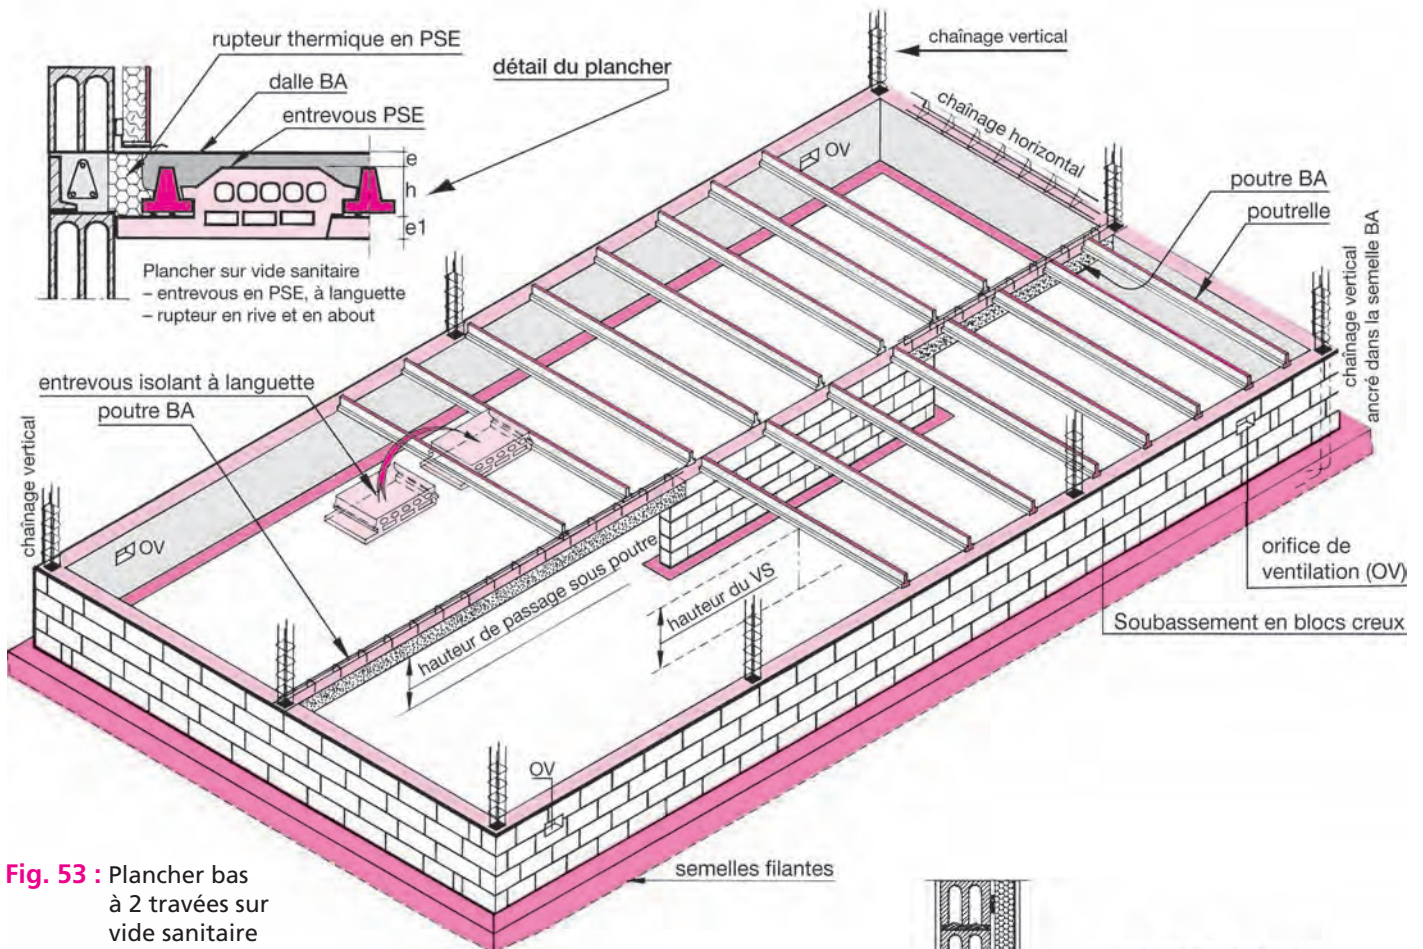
Plancher bas à 2 travées sur vide sanitaire
